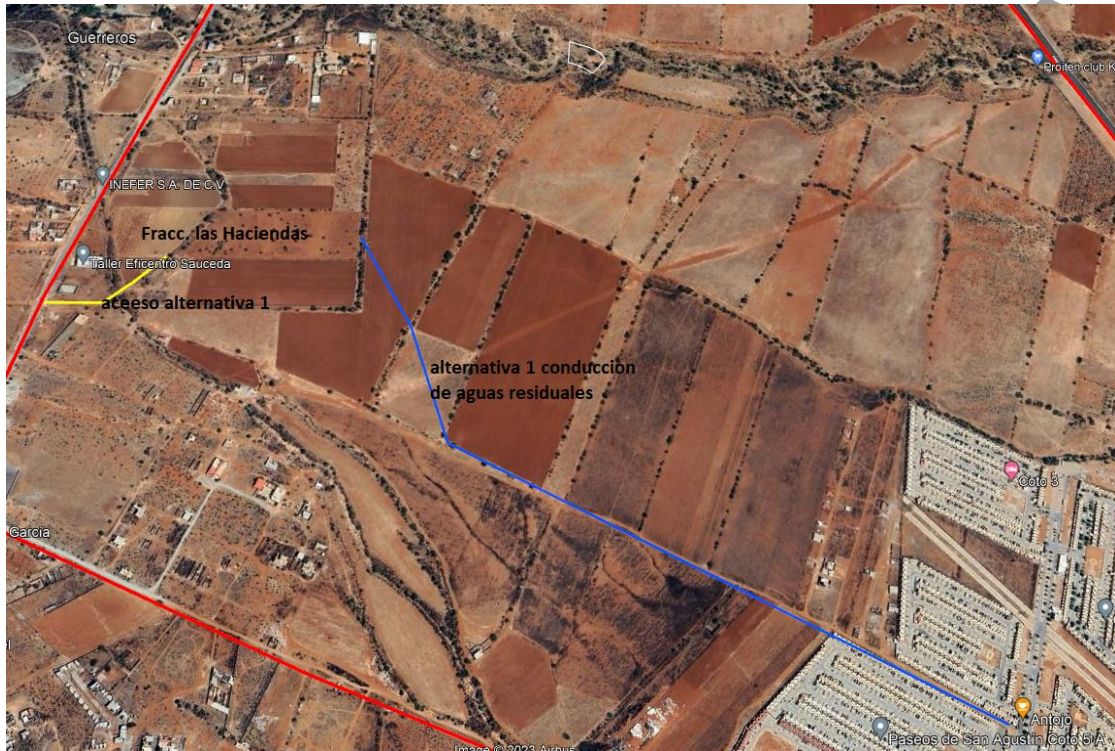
ALTERNATIVA 1 PARA LA CONSTRUCCIÓN DE OBRAS HIDRÁULICAS EN EL DESARROLLO DEL FRACCIONAMIENTO LAS HACIENDAS
